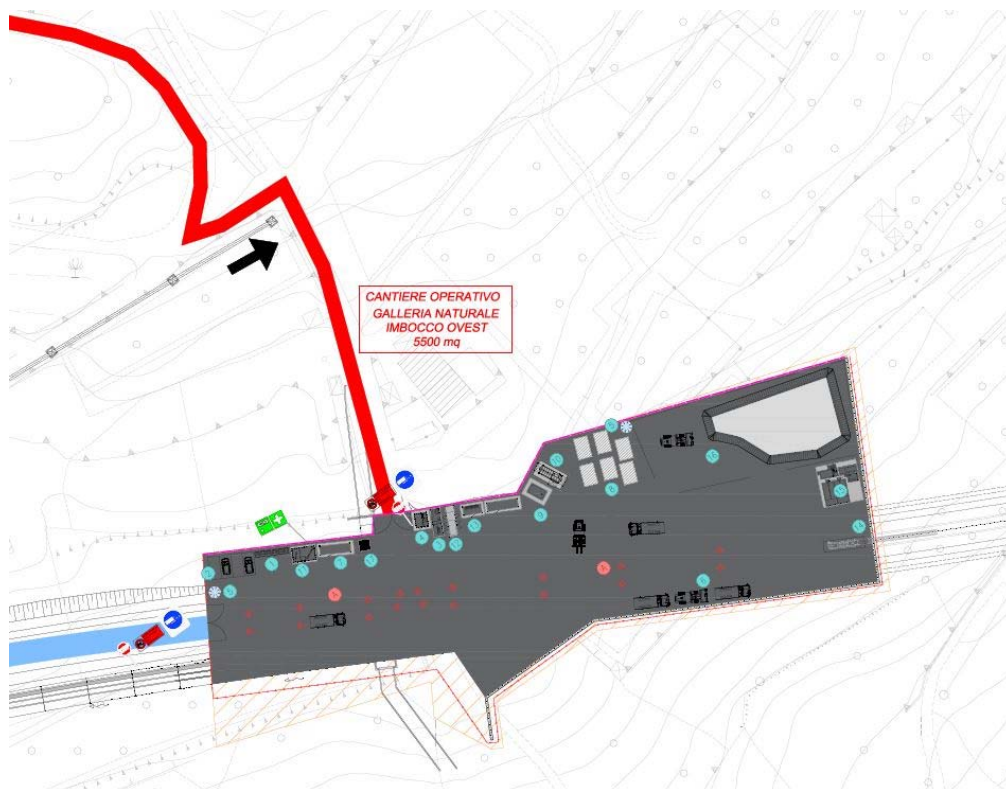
AREA CANTIERE IMBOCCO OVEST G.N.
